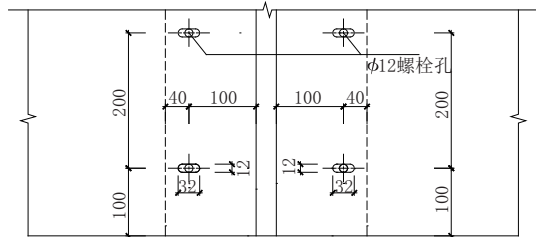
伸缩缝处不锈钢板安装平面图(单位:mm)
